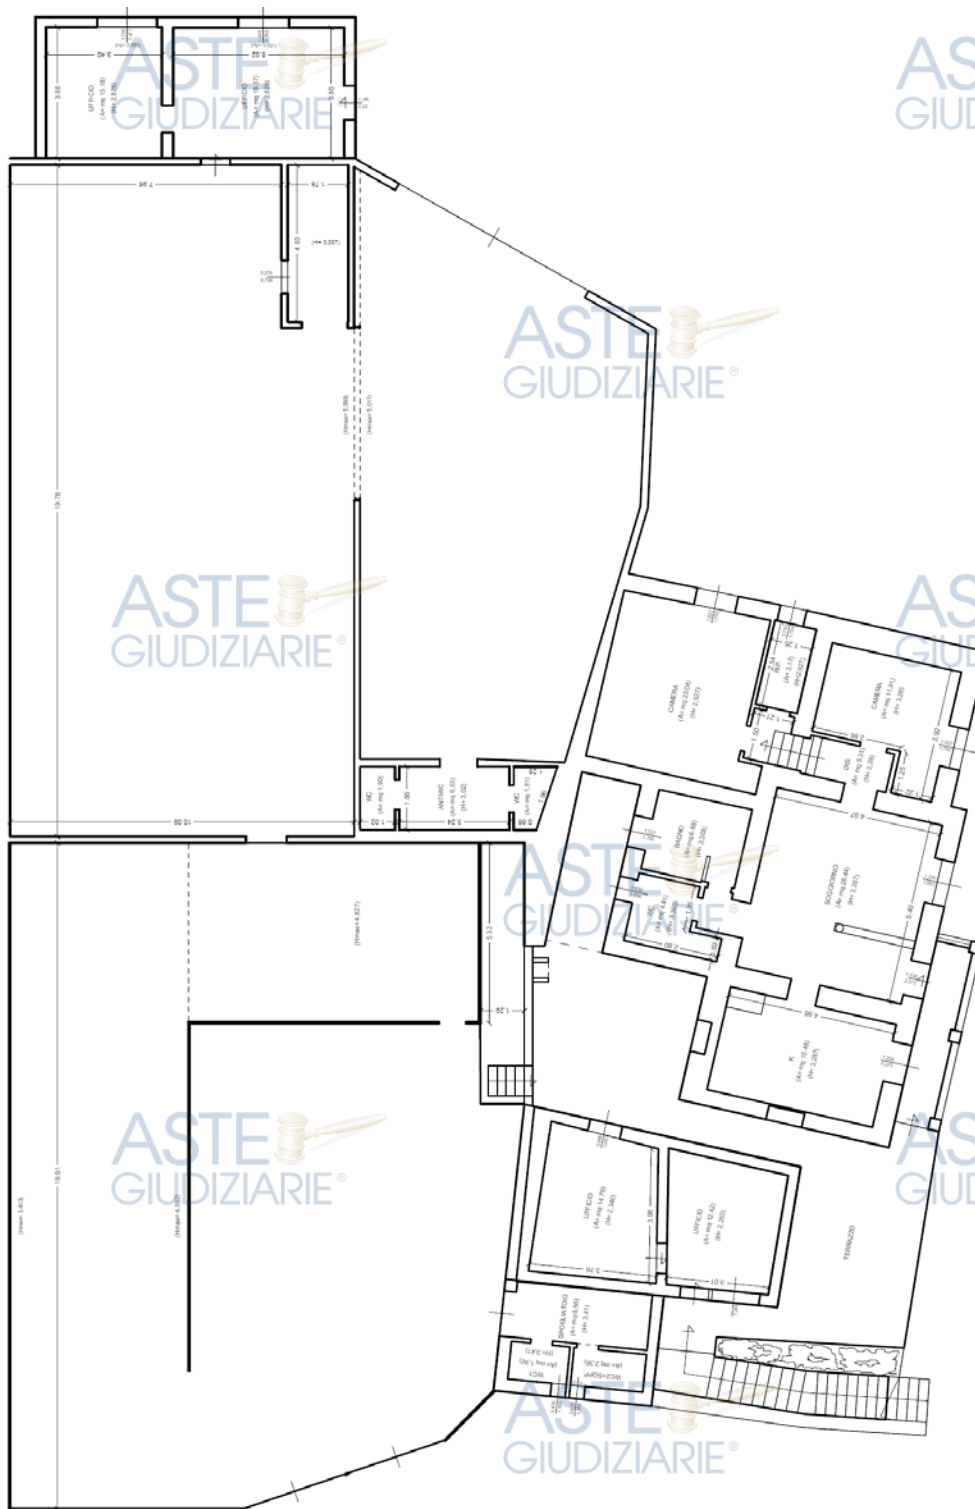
Planimetria dello stato dei luoghi rilevato dal CTU
